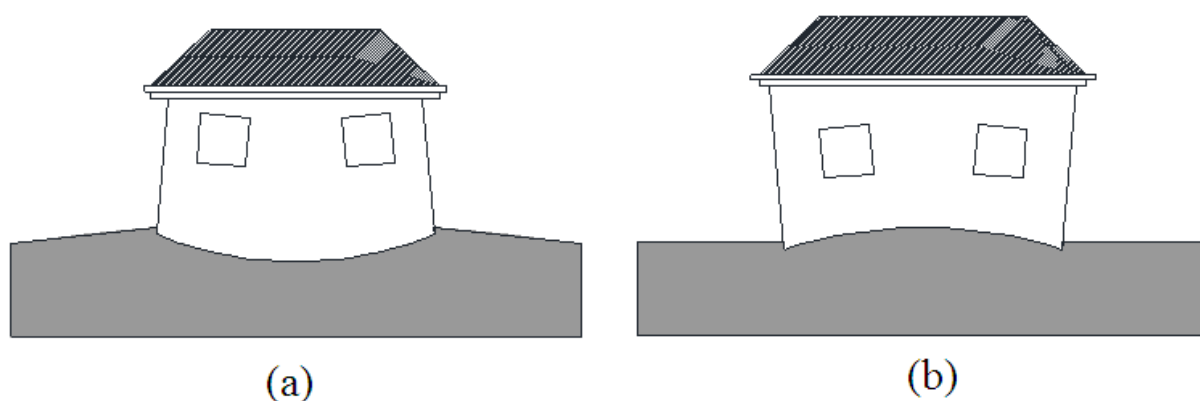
Вредное влияние набухающих грунтов на здания.
